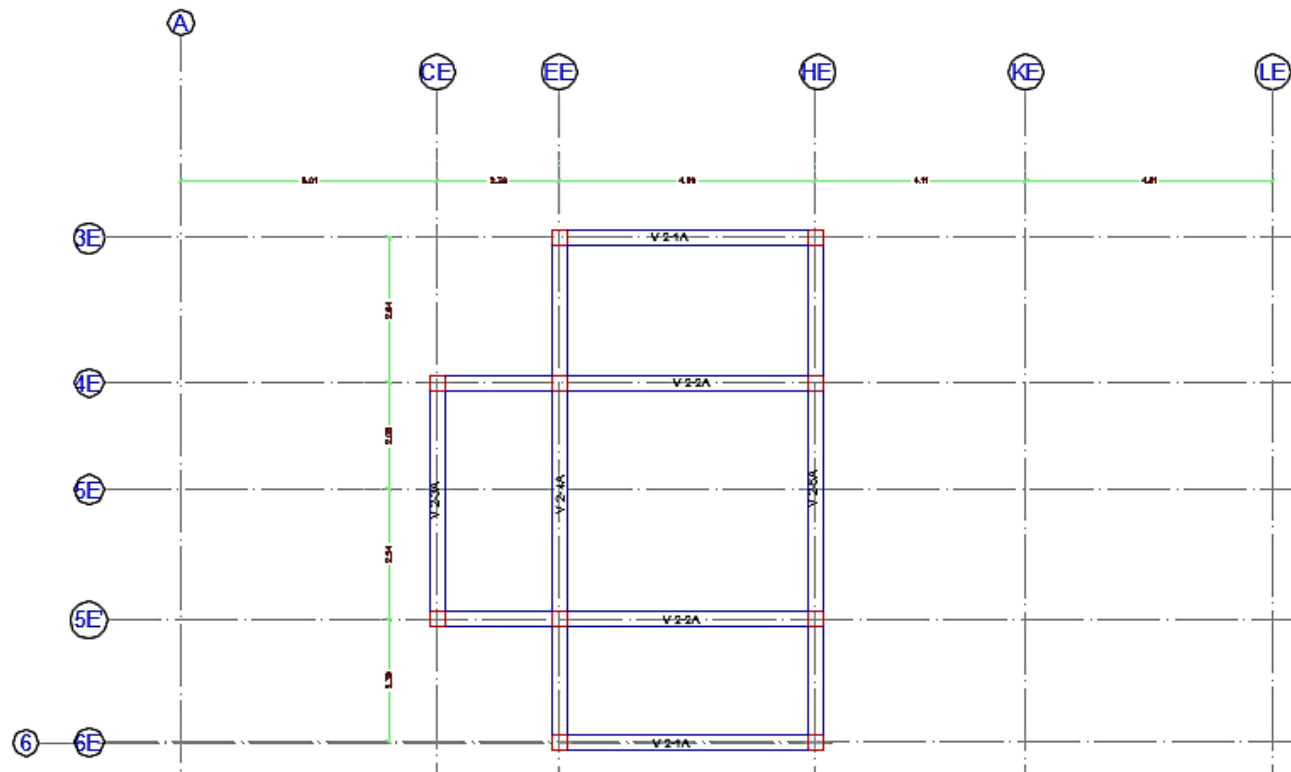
Plano estructural zona A, nivel 6.90 m. Fuente: Autor
